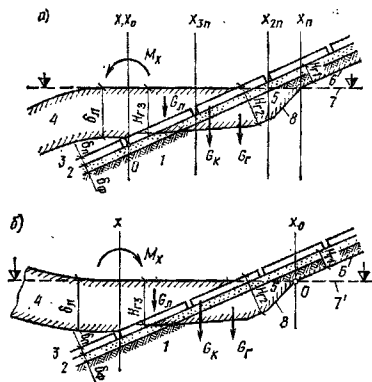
Схемы сил к расчету устойчивости крепления при опускании (а) и подъеме (б) ледяного покрова
